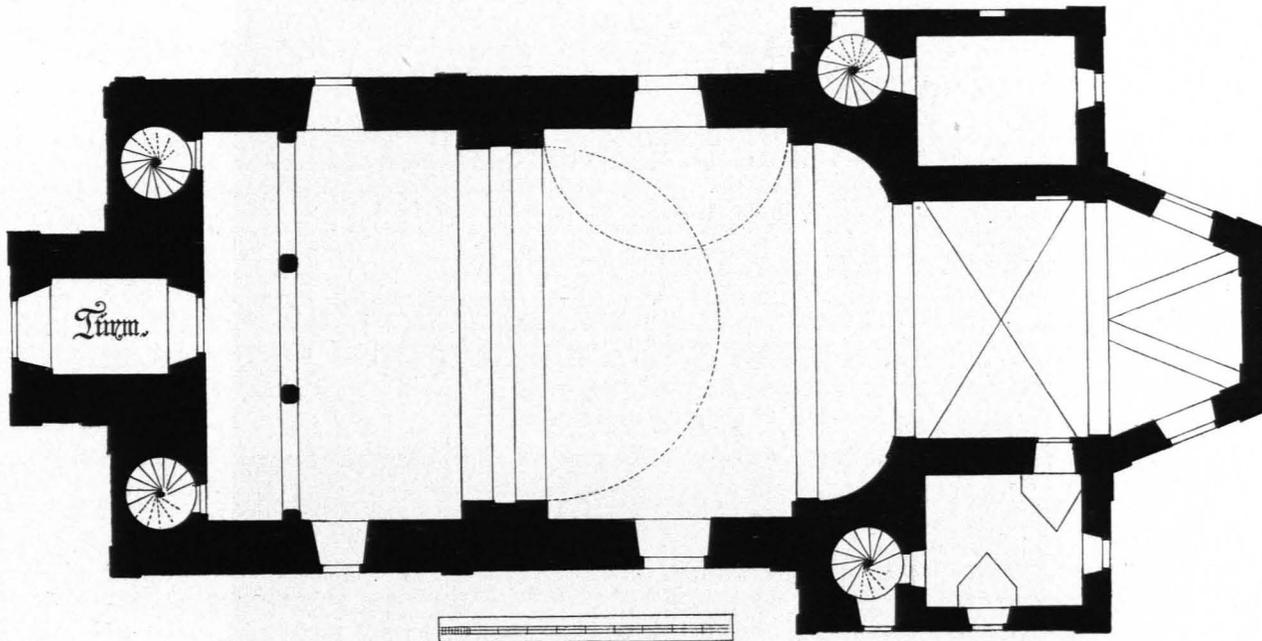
Arbesbach, Pfarrkirche, Grundriß 1 : 250 (S. 209)
